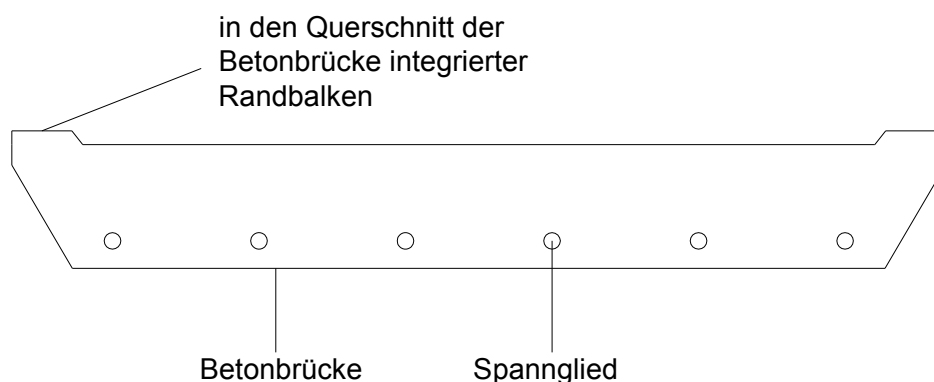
Querschnitt einer vorgespannten Betonbrücke ohne Betonstahlbewehrung, Abdichtung und Fahrbahnbelag
